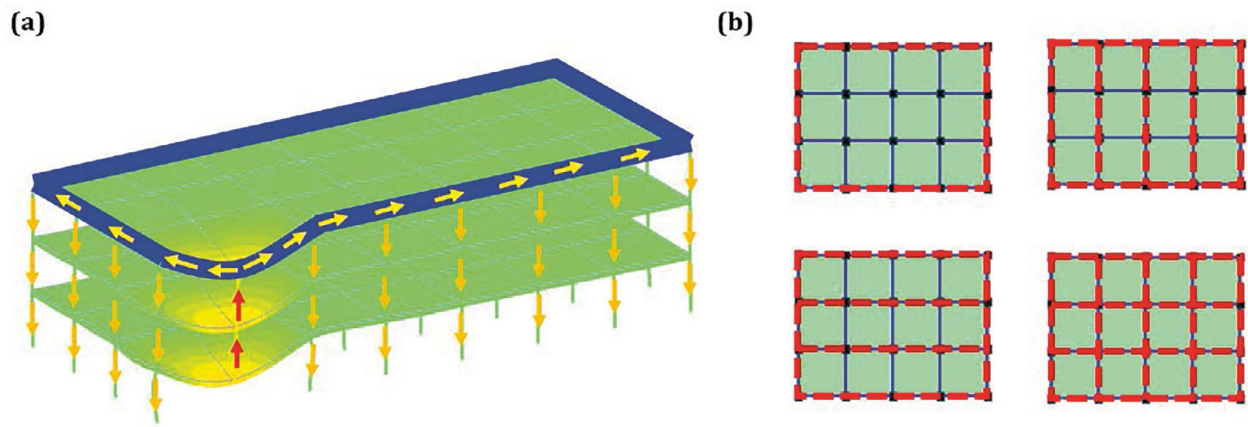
Método de refuerzo del proyecto ENHANCE: (a) Esquema del funcionamiento estructural; (b) Ejemplos de posibles disposiciones de la viga de refuerzo en cubierta.
